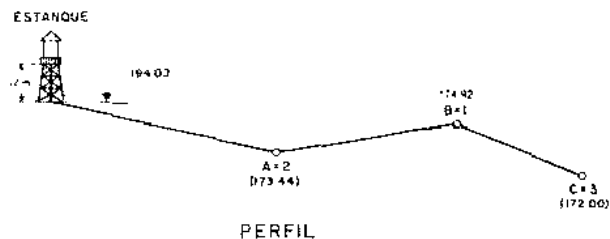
Perfil y planta de la aducción del ejemplo anterior.
